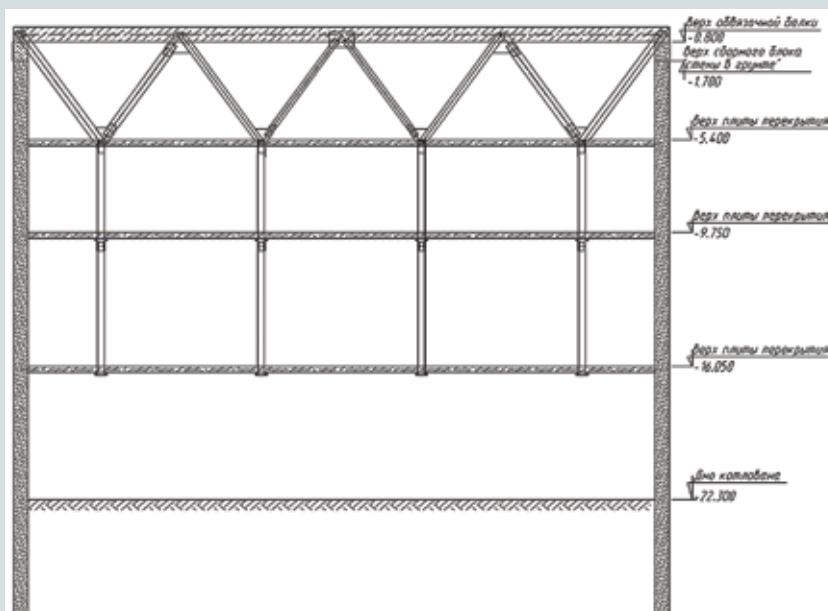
Пространственная распорная система, обеспечивающая крепление котлована глубиной 20 м четырьмя капитальными перекрытиями
